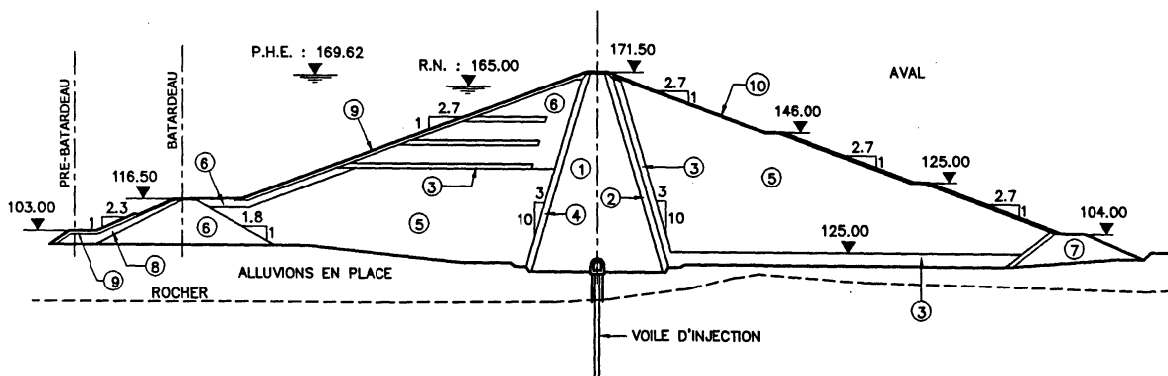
Coupe type transversale du barrage de Taksebt.
